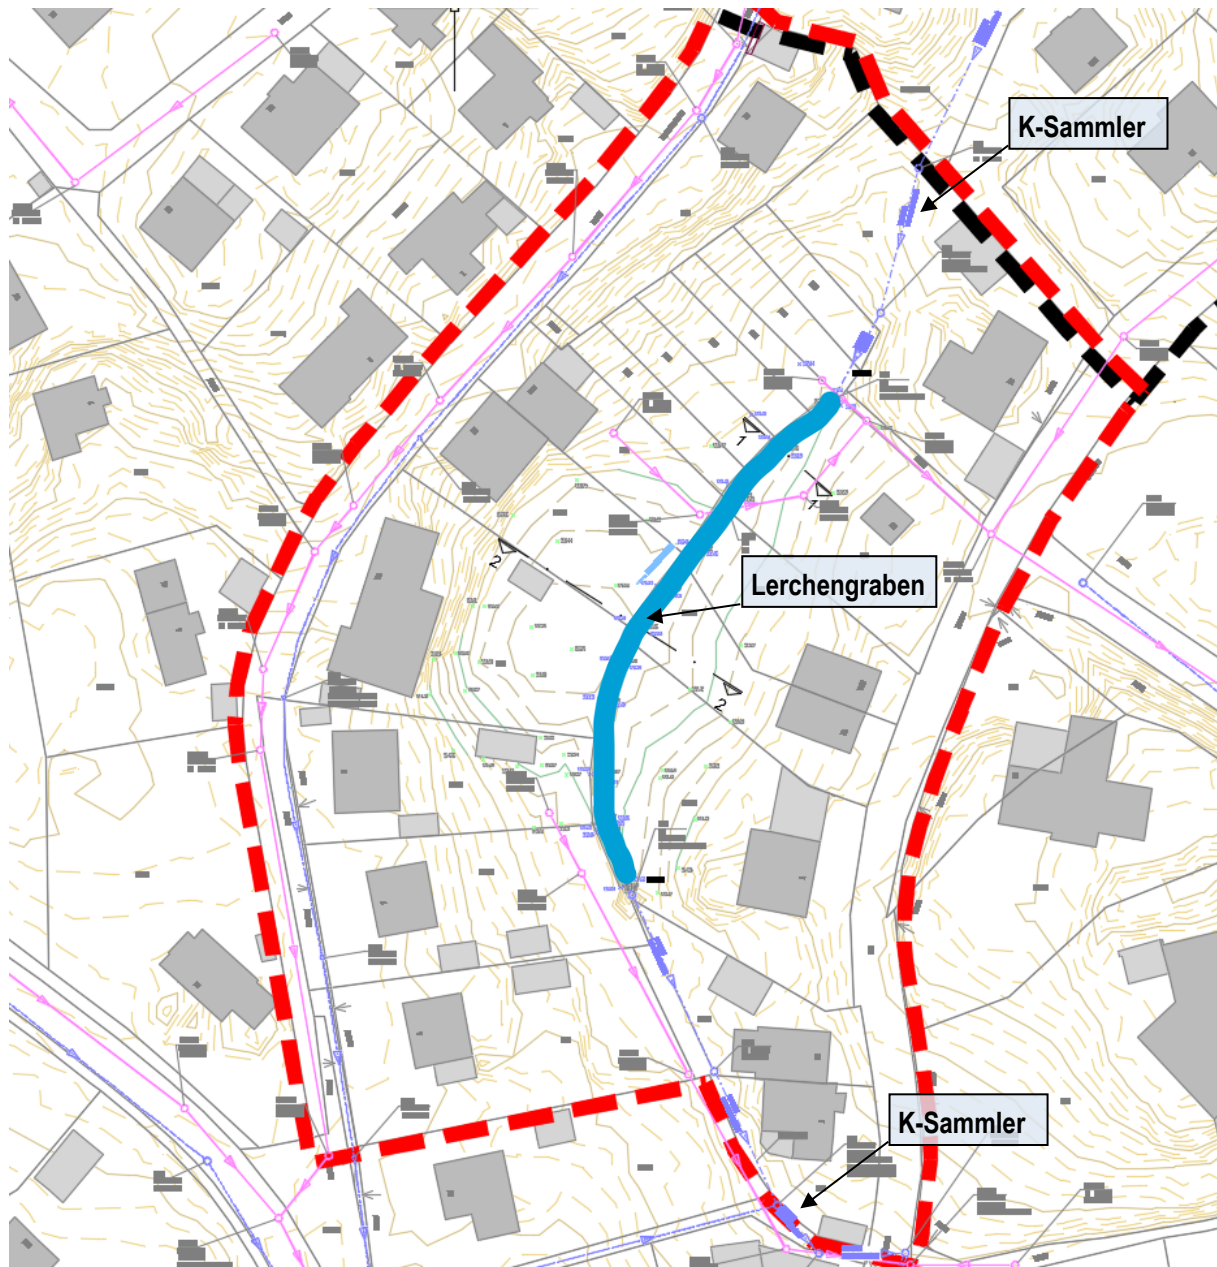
Lageplan mit Umgriff Baugebiet „Am Pechhölzl / Lerchenstraße, Abschnitt Süd“
